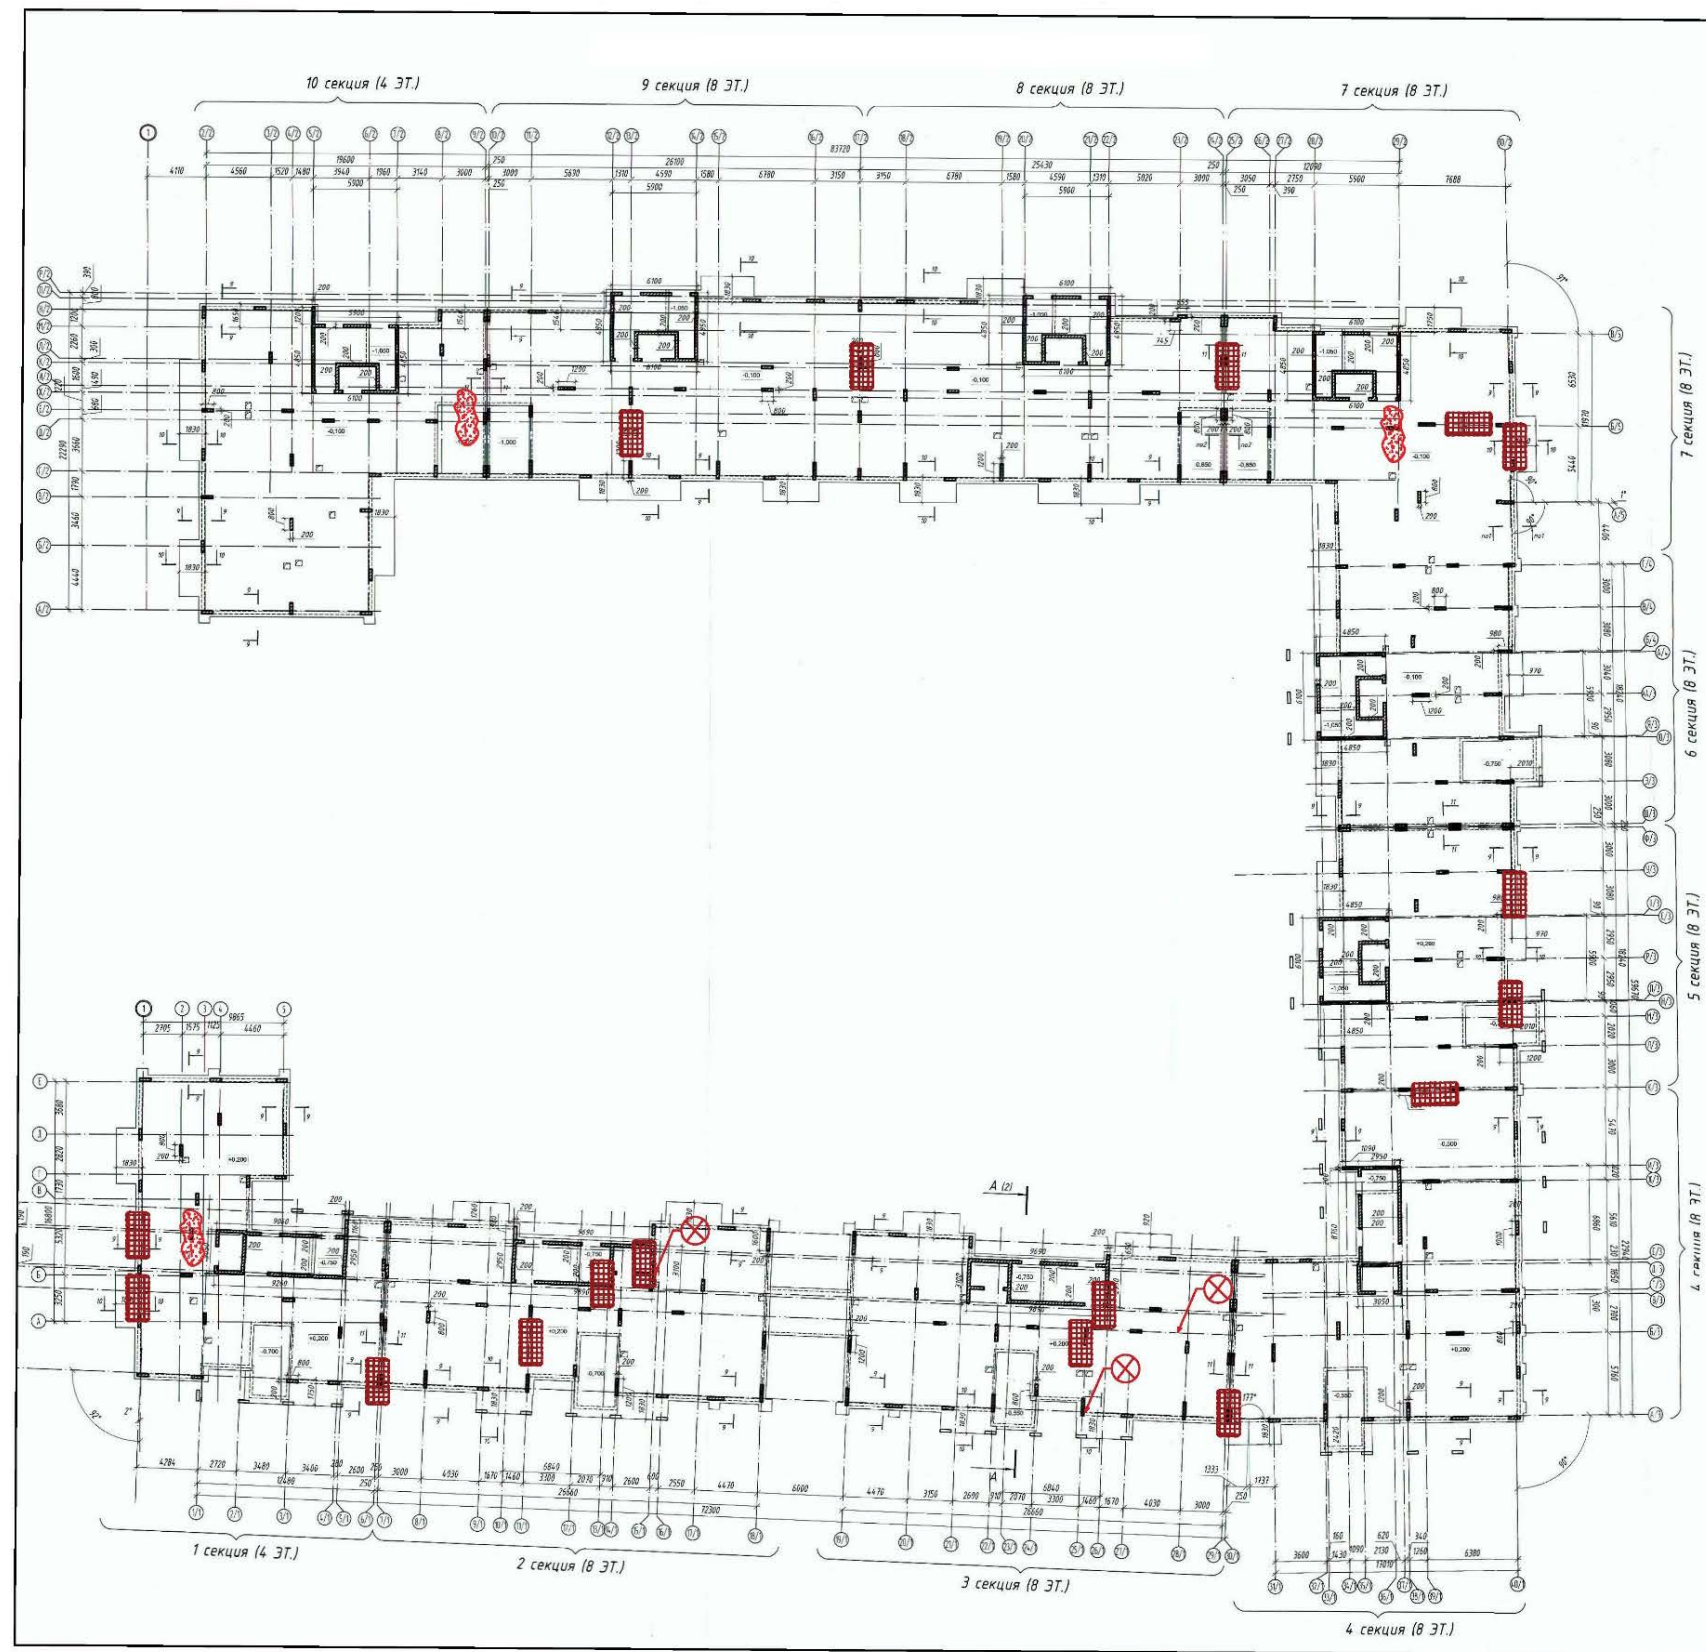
Карта дефектов верхней плоскости плиты перекрытия первого этажа вертикальных конструкций 2-го этажа
